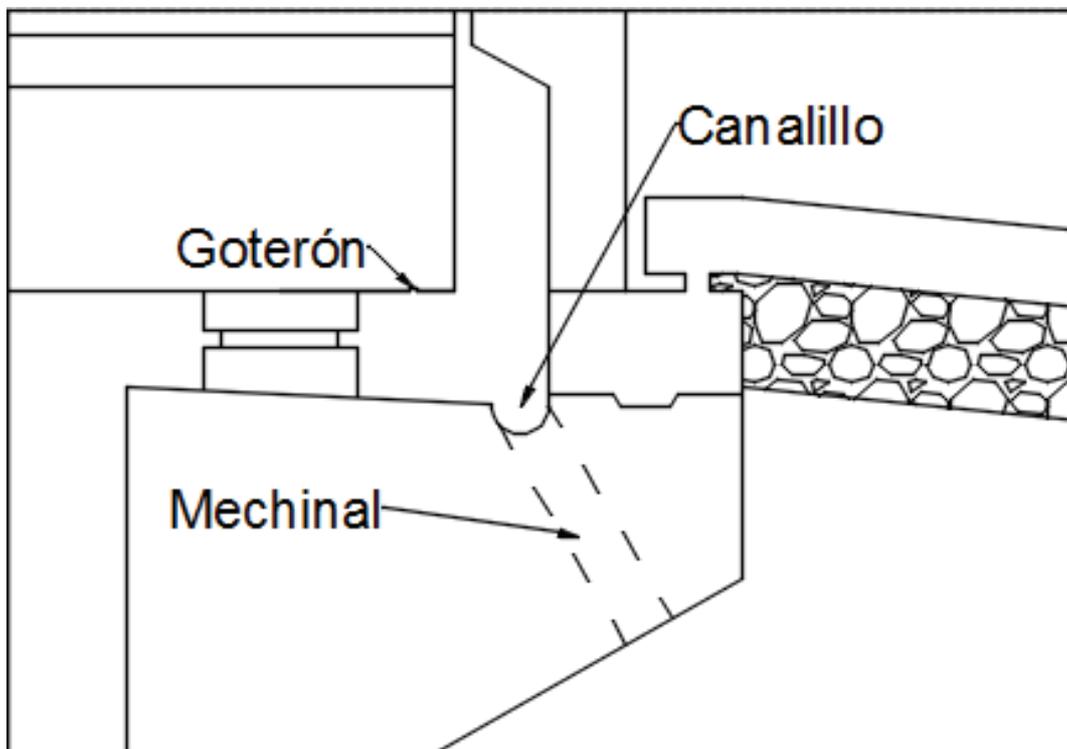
Detalle del drenaje de la zona de apoyo de la pasarela en el estribo.
